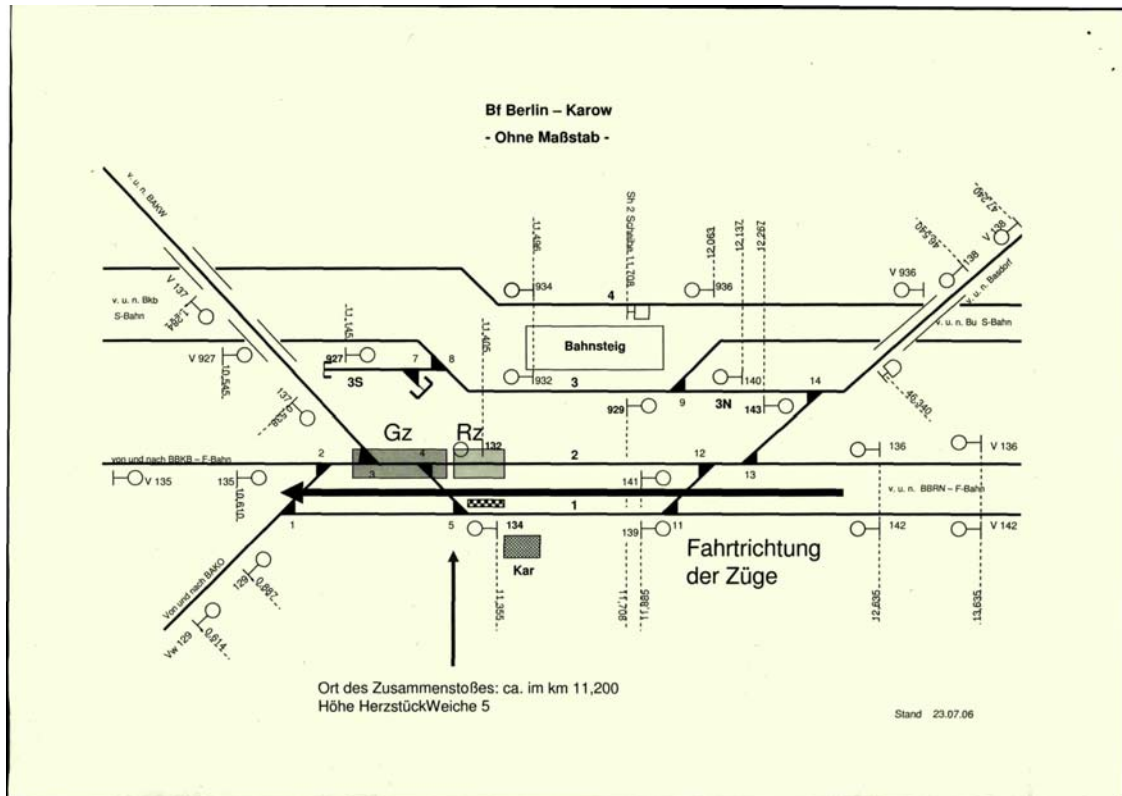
Lageplan mit Stellung der Unfallzüge
